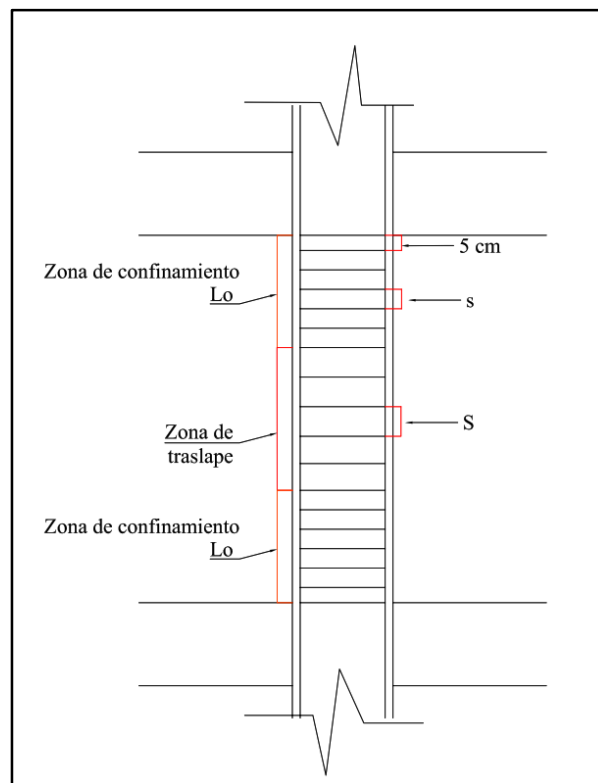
Separación de estribos y longitud de confinamiento en columnas. Fuente: Elaboración propia basado en la NEC [3].
